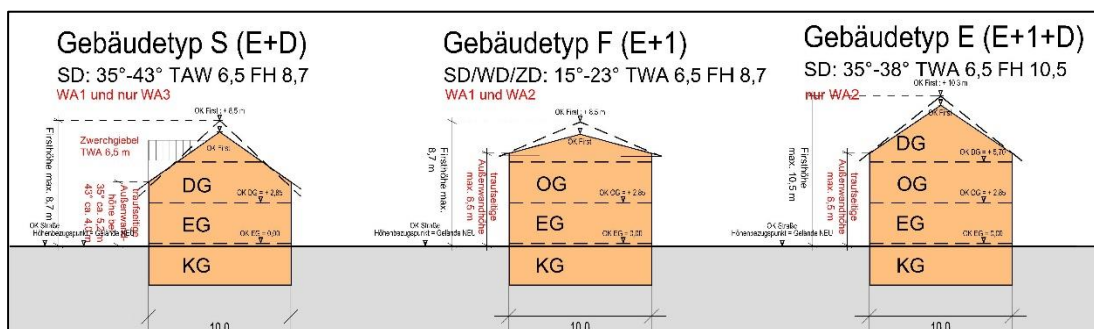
Gebäudetyp S (spitzgiebliches Dach - „E+D“), Gebäudetyp F (flachgeneigtes Dach „E+1“) und Gebäudetyp E (klassischer Einfirsthof „E+1+D“)
